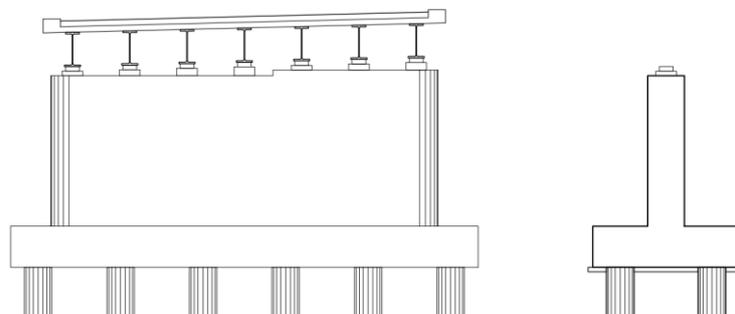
Sezione Strutturale Tipo del Viadotto
